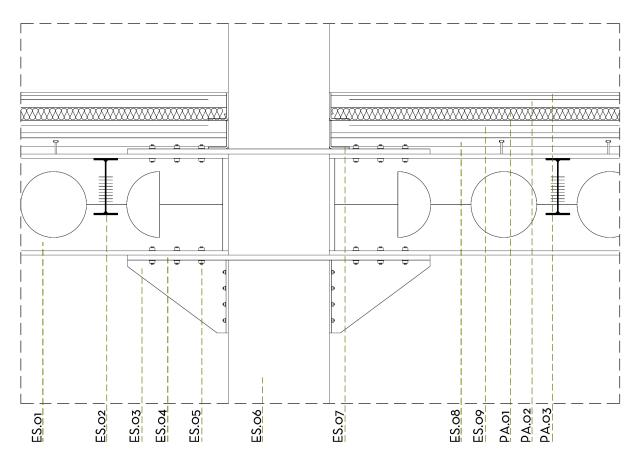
| Detalle encuentro viga de primer ordeny pilar
